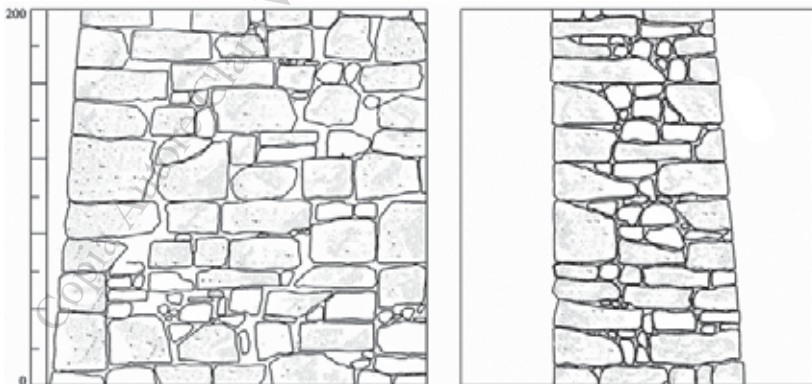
Musellaro (Pe), palazzo Tabassi, apparecchio murario in blocchi di calcare e travertino del prospetto principale.
